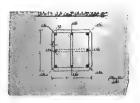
مسقط أفق يين موقع محطة الطلمبات ومواقع كتل ديزل
